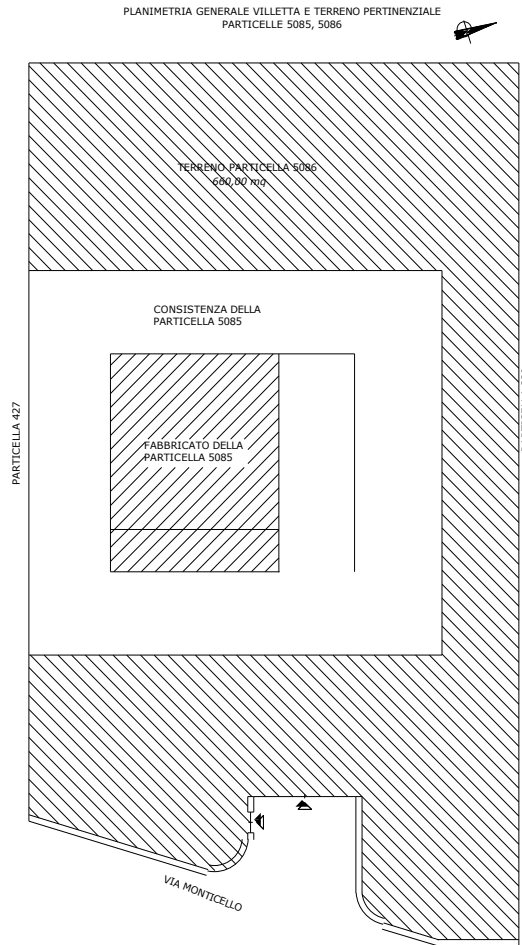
planimetria generale della villetta con i terreni pertinenziali
